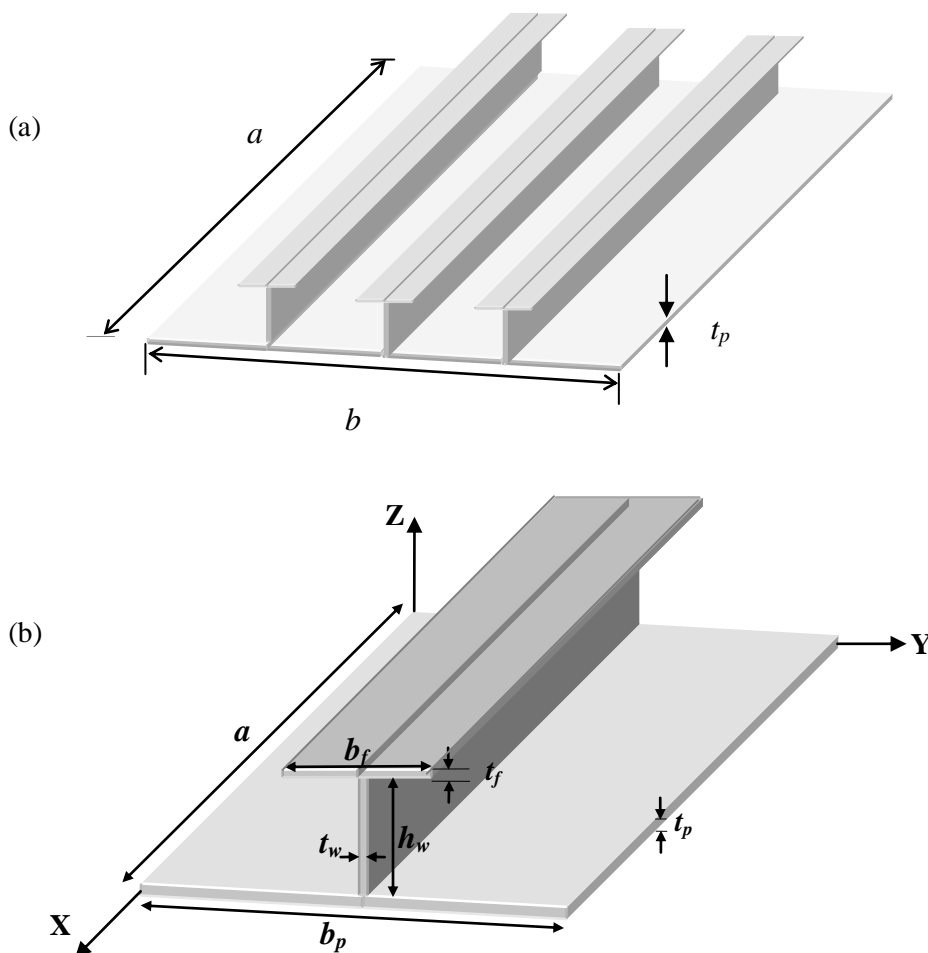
Painel enrijecido: (a) Dimensões geométricas. (b) Seção transversal
